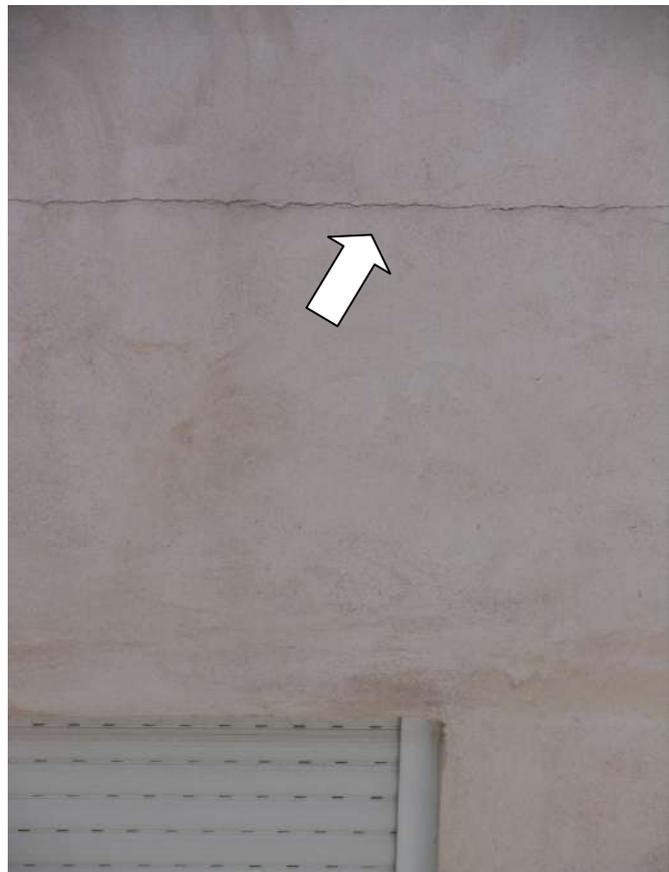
Otro caso de fisura en fachada patio de luces.
